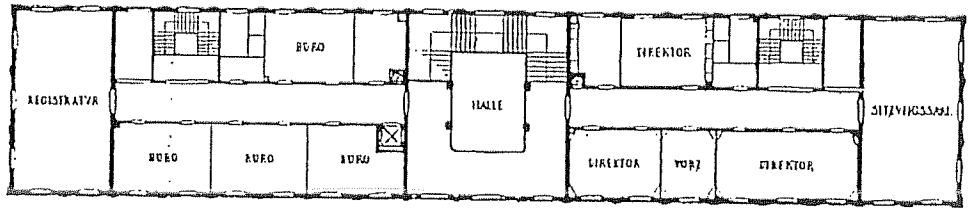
Geplanter Grundriss des 1. Obergeschosses. Von der zentralen Halle sollten im Erd- und im Obergeschoss die beiden Trakte erschlossen werden (der linke/nördliche ist nicht realisiert worden). Die Durchgangsöffnungen der Halle führten zu den Mittelfluren, die jeweils vor größeren, saalartigen Räumen auf den beiden Kopfseiten des Gebäudes endeten (z. B. im 1. OG ein „Sitzungsaal“ im Süden und eine „Registratur“ im Norden). In jedem Trakt war noch je ein weiteres kleineres Treppenhaus zum Hof hin geplant, an den sich jeweils auch Toiletten anschlossen. Der Vertikalerschließung dienten außerdem drei Aufzüge an den Innenwänden der Zentralhalle davon zwei als kleine Lastaufzüge hofseitig und ein größerer Personenaufzug straßenseitig. Die übrigen Räume waren hinsichtlich ihrer Längen flexibel gestaltet. Bildvorlage: Deutsche Bauhütte Jg. 29/1925, S. 117.
